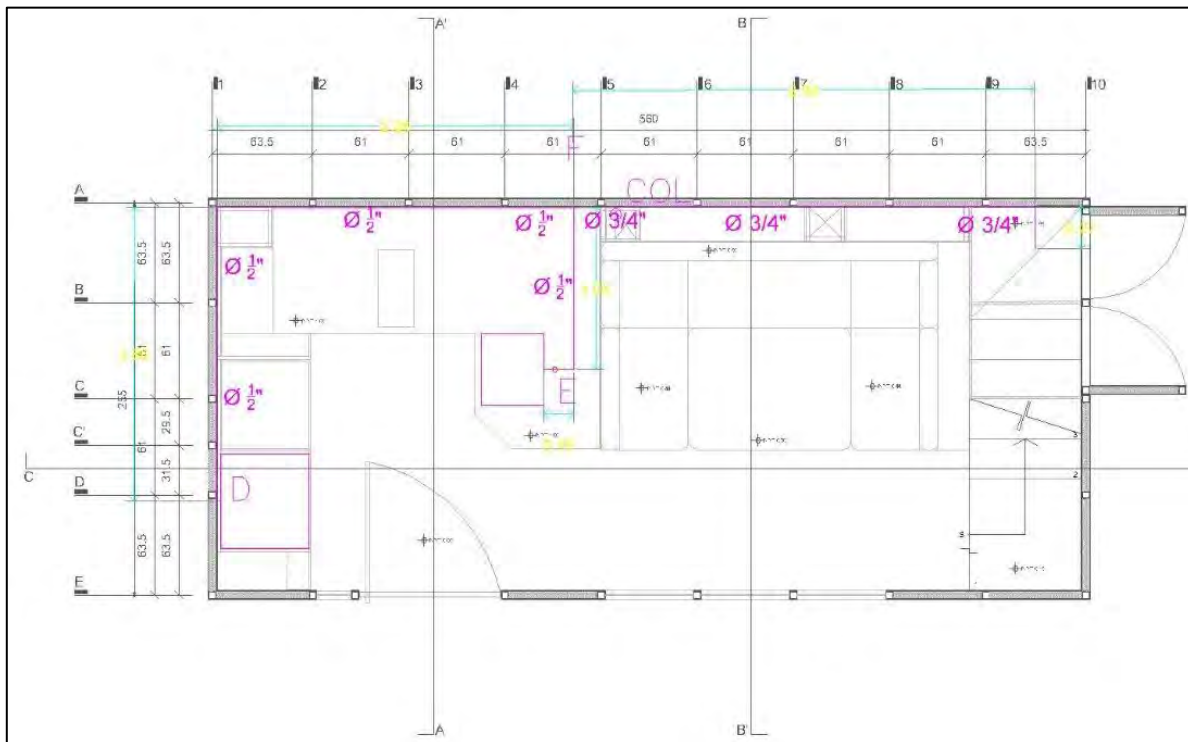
, Diámetros de la instalación de agua fría, Planta baja
